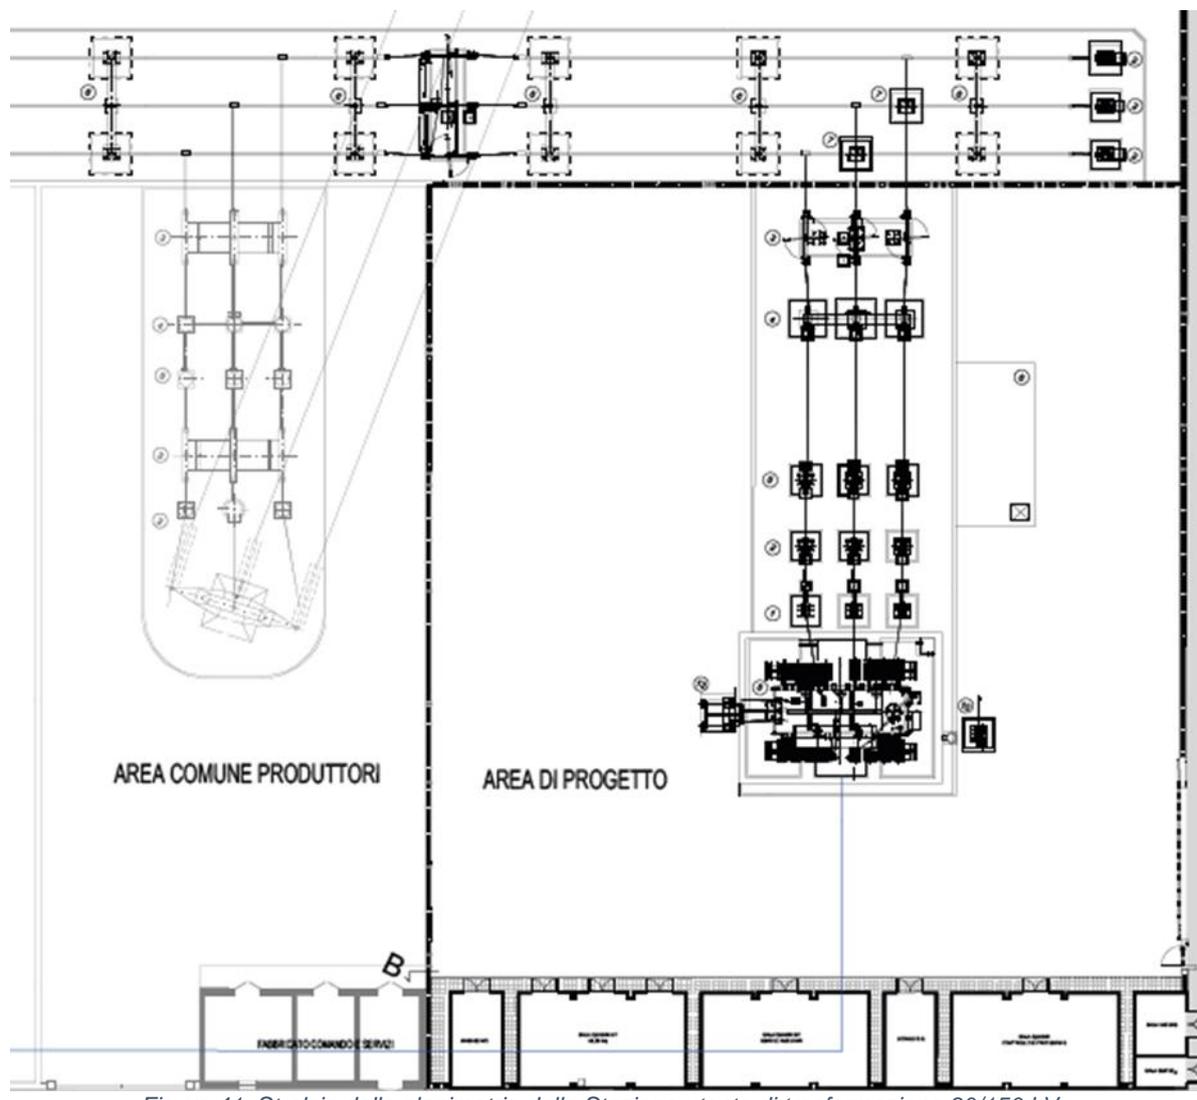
Stralcio della planimetria della Stazione utente di trasformazione 30/150 kV
